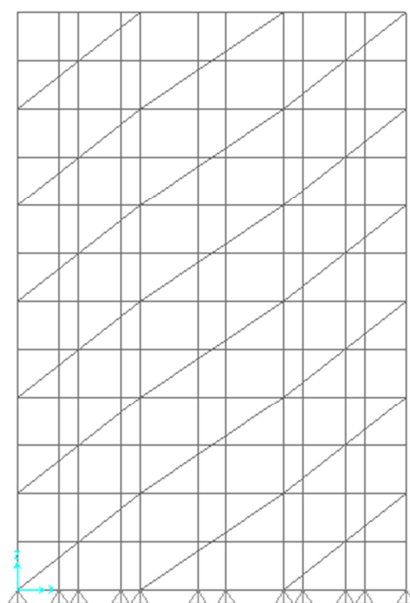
Configuração dos Planos de Contraventamento Vertical Com Elementos de Contraventamento Grandes
